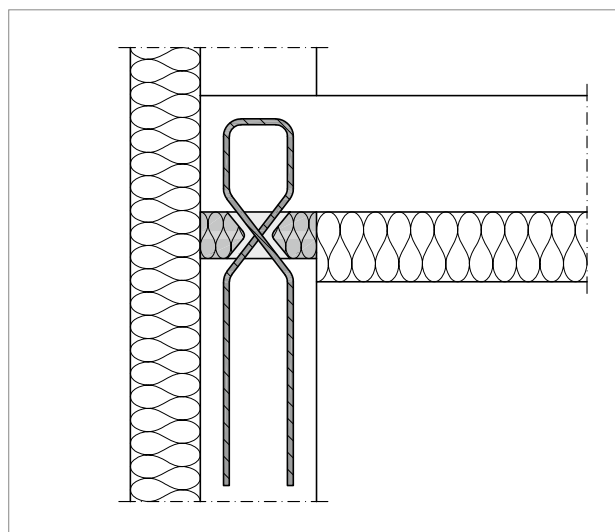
Schöck Sconnex® type W-N-VH : mur extérieur ; isolation sous la dalle selon la coupe B-B
